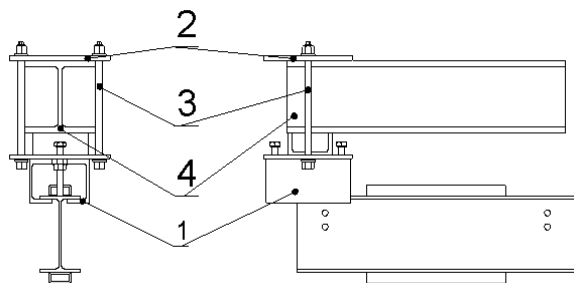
Крепление без сверления отверстий в несущей конструкции
